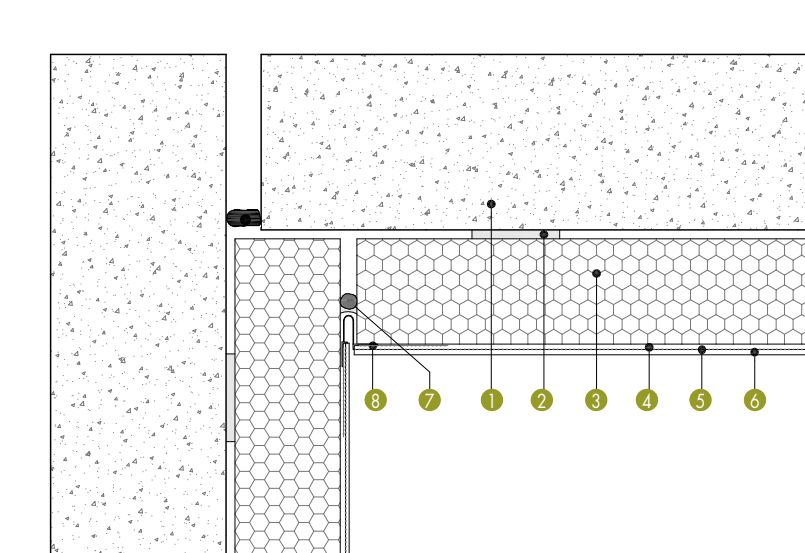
Joint de dilatation - angle rentrant (coupe horizontale)
